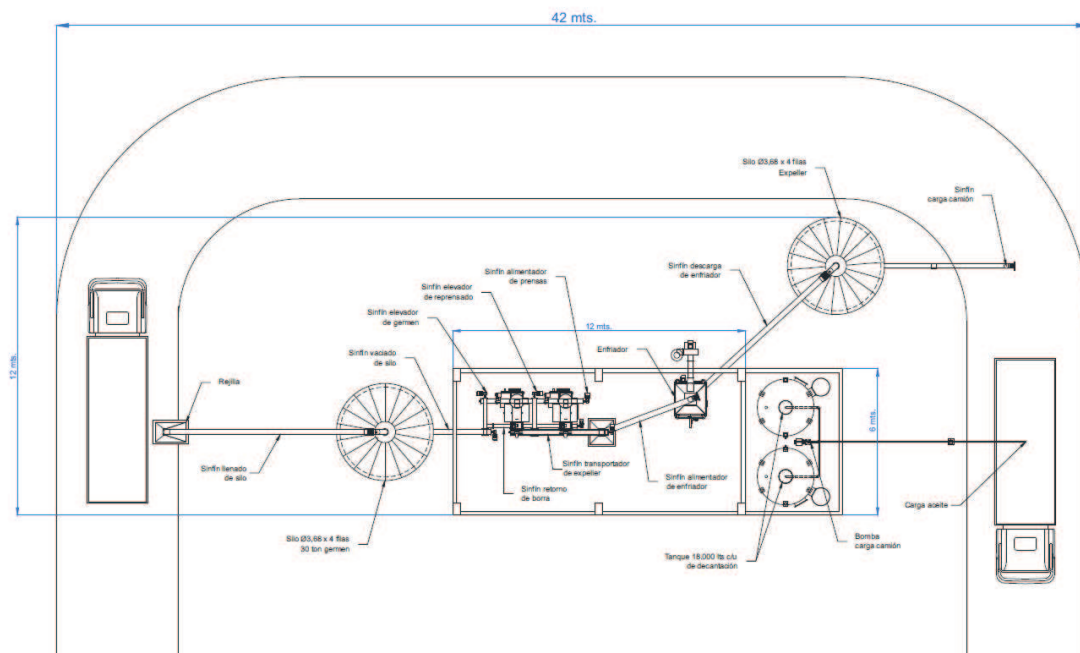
Plano de distribución de las instalaciones de la planta de extracción
